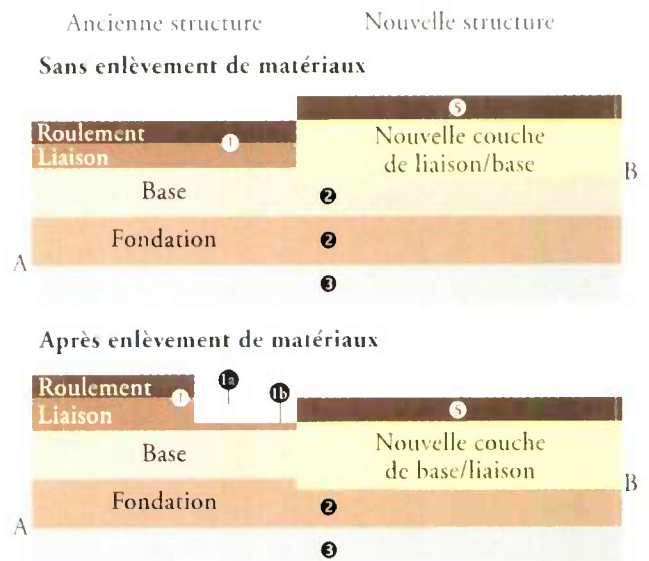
Structures de chaussées obtenues par retraitement. Cas d'un défaut dans les couches de surface.
